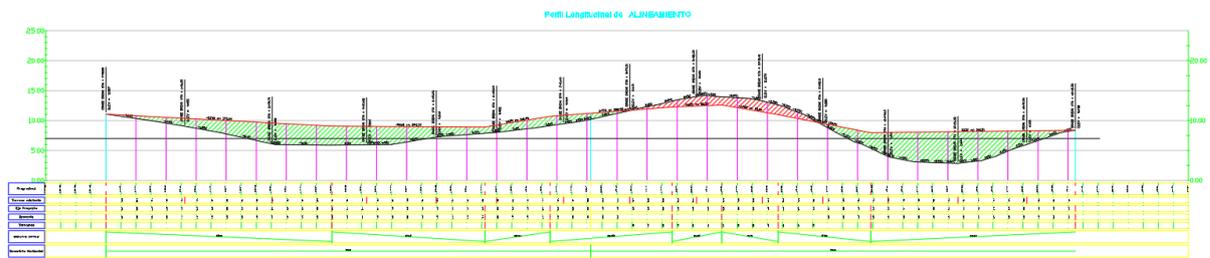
Perfil longitudinal del camino. Fuente: propia.
